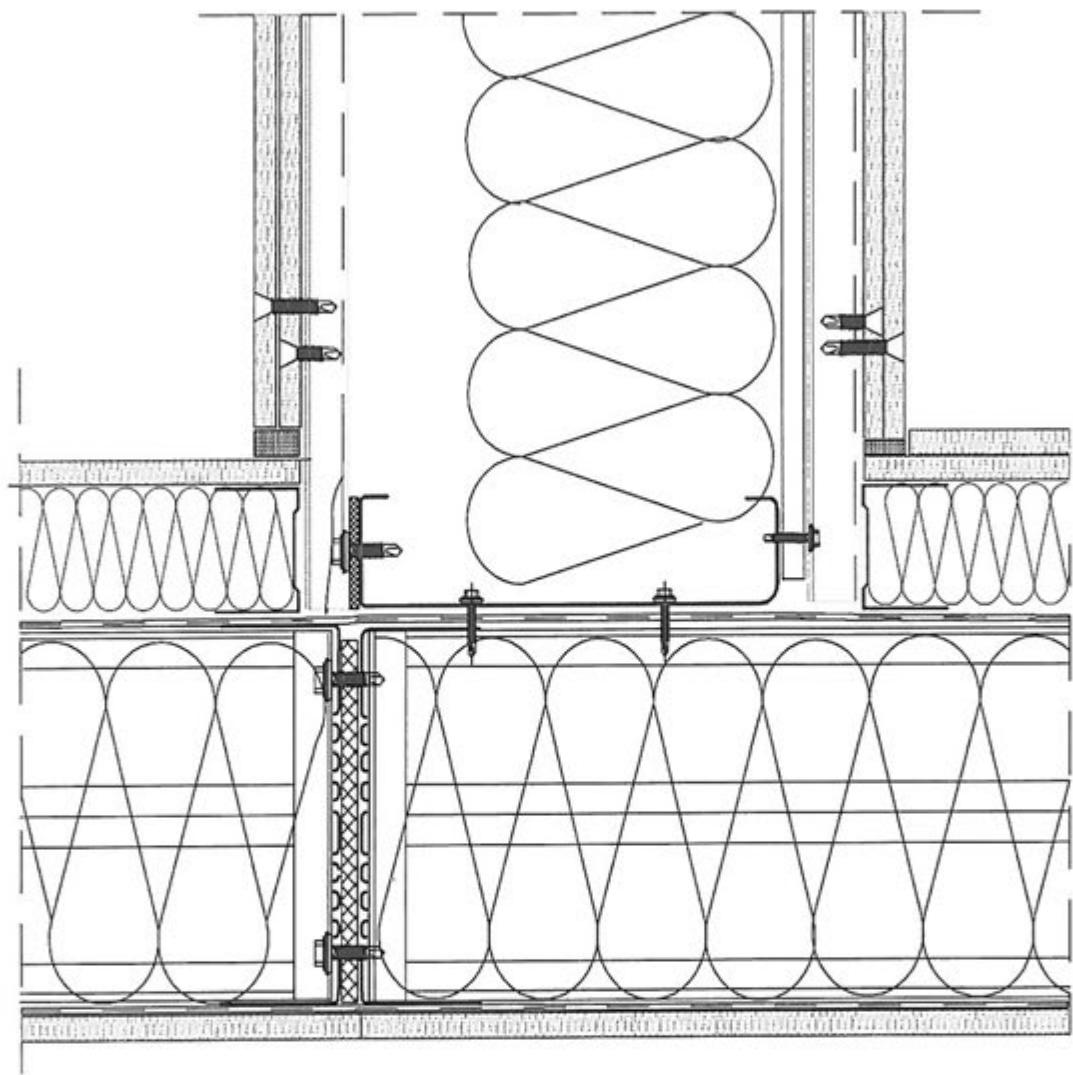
Узел крепления и примыкания конструкции междуэтажного перекрытия к наружной несущей стене.
